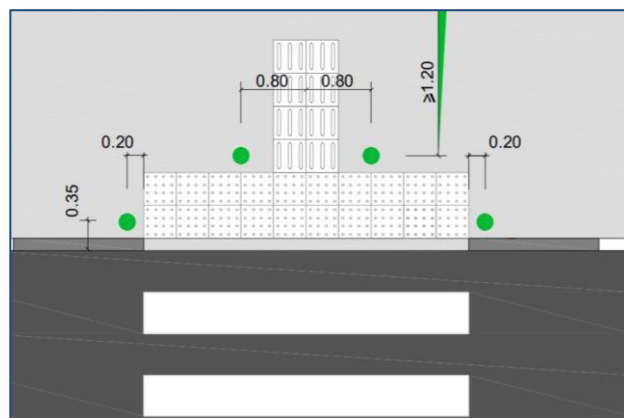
Exemplo de instalação correta dos pilaretes nos passeios adjacentes as travessias pedonais [34]
